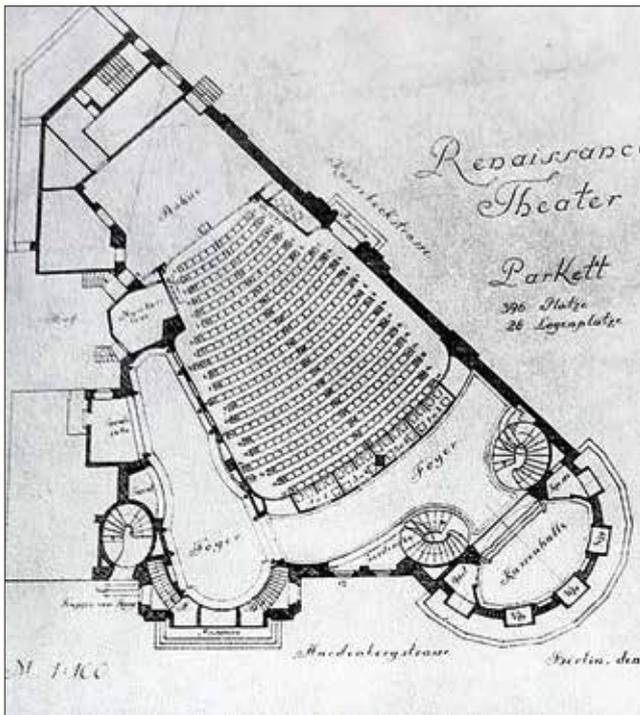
Grundriss Erdgeschoss, 1927
